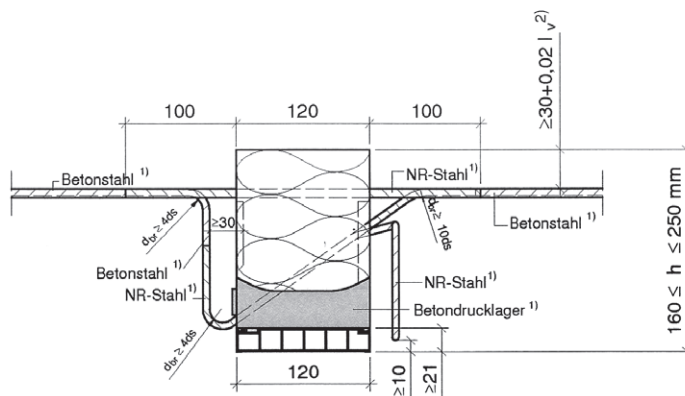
Beispiel Schöck Isokorb Typ RK-240 mit Druck- Querkraft Kombination, integrierter Aufhängebewehrung und Drucklageraufhängung
